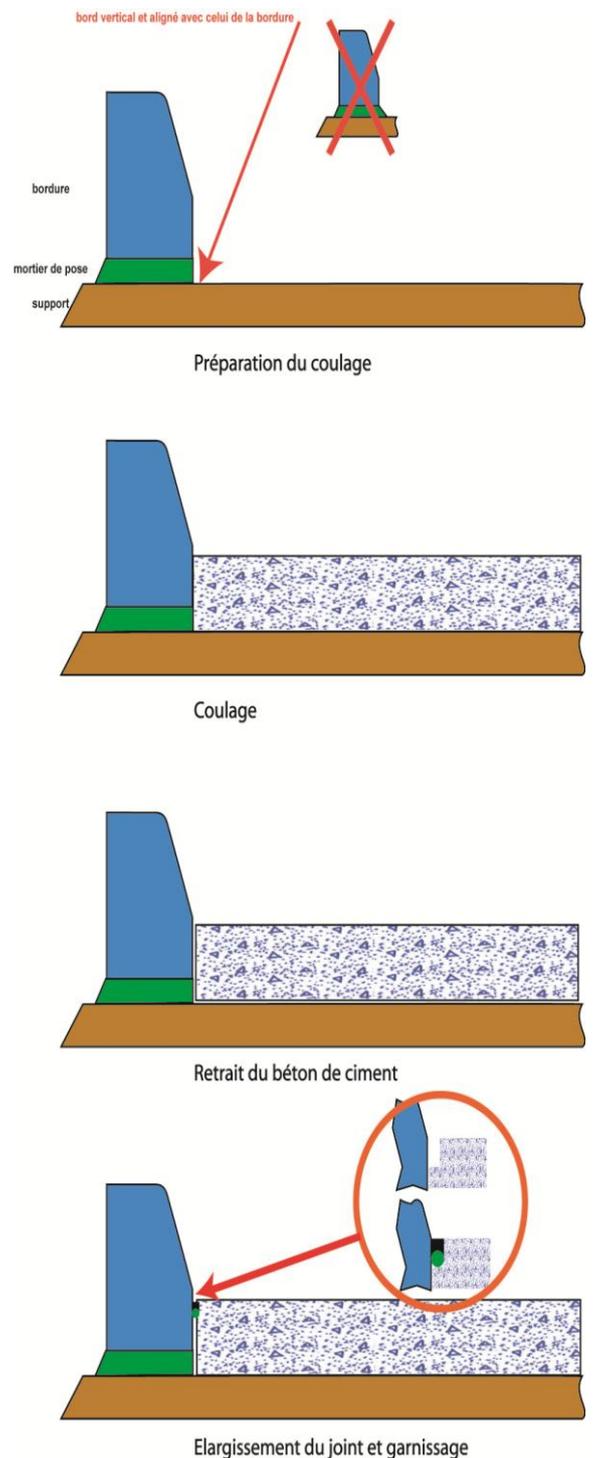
Principales opérations du coulage du revêtement entre bordures de trottoir
